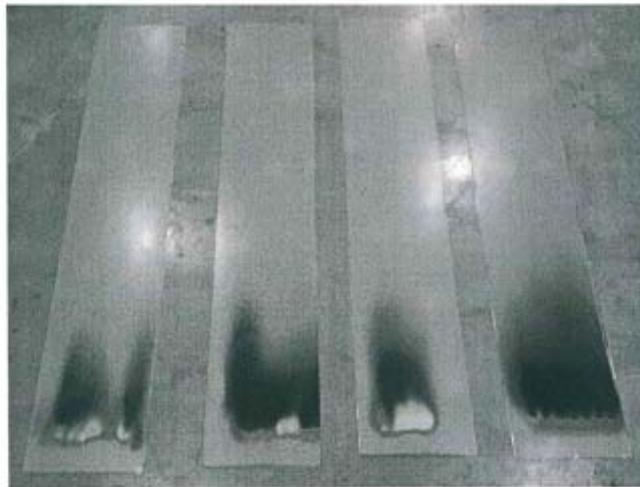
Образцы панелей металлических фасадных окрашенных после испытания по ГОСТ 30244-94.
